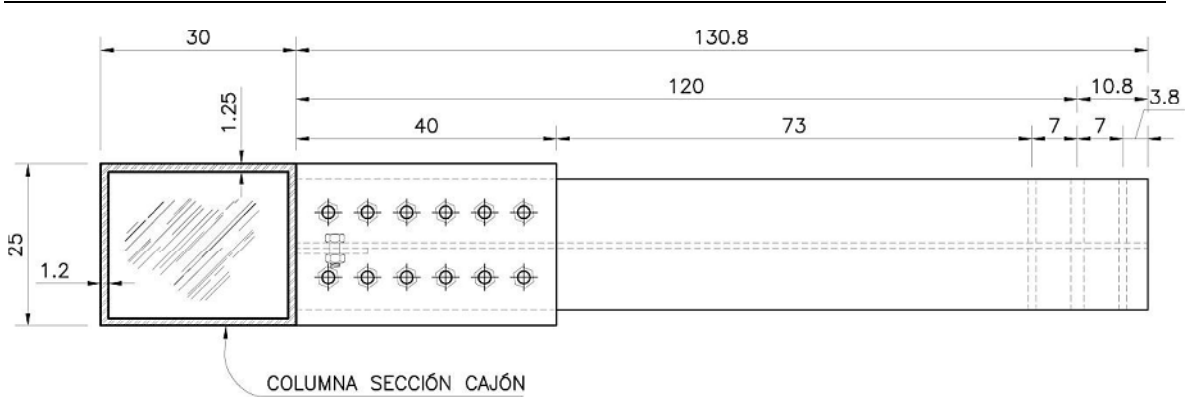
Conexión BFP3 con columna cajón vista en planta
